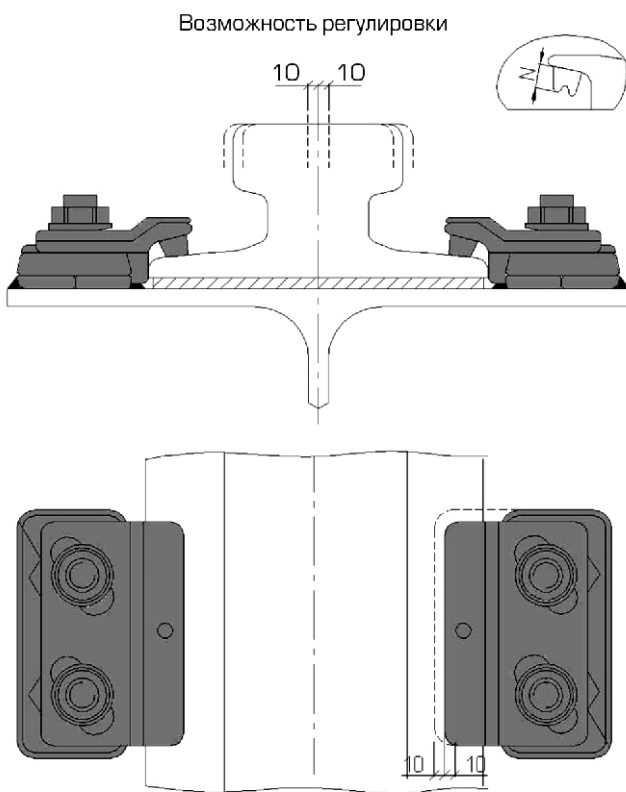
Прижимные планки на сварных подкладках с двумя болтами
